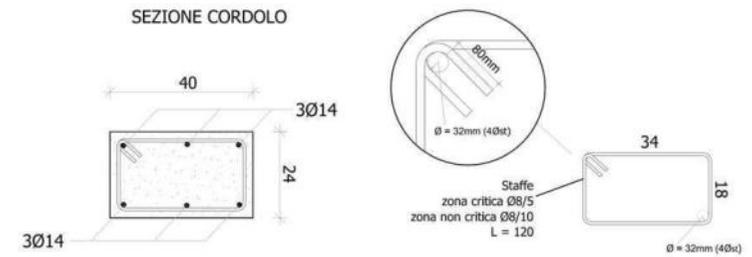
Particolare 1: sezione e staffe del cordolo
